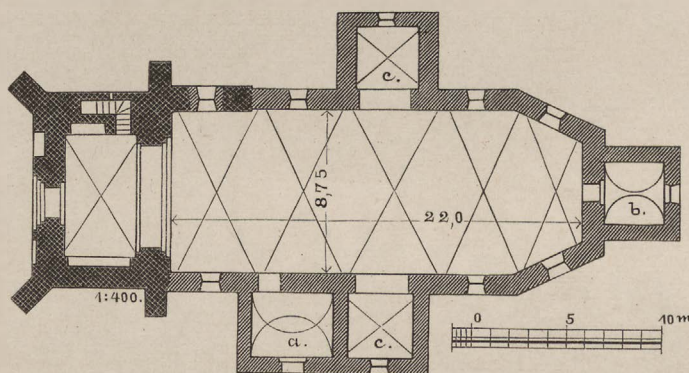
Kirchenjahn. Grundriss der Kirche.
